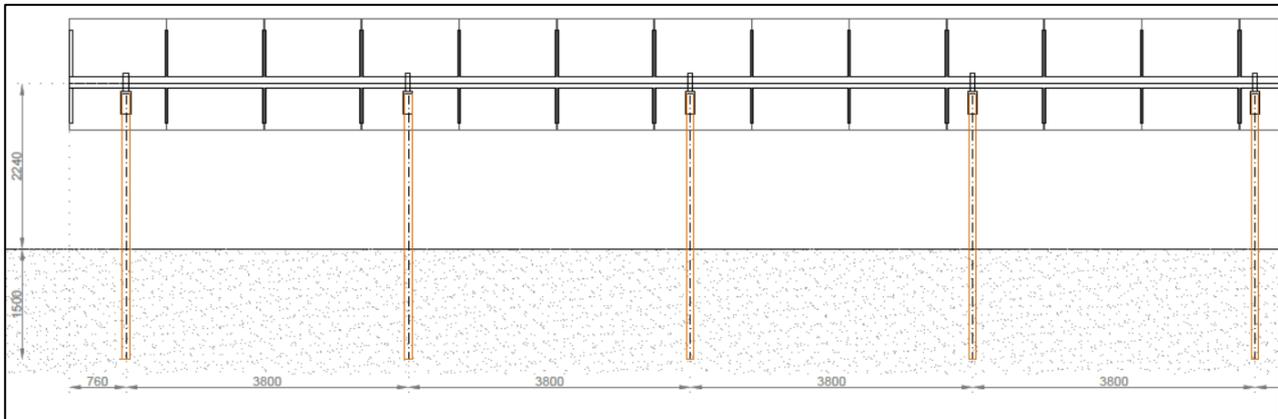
stralcio prospetto struttura di supporto 1x30P-30
